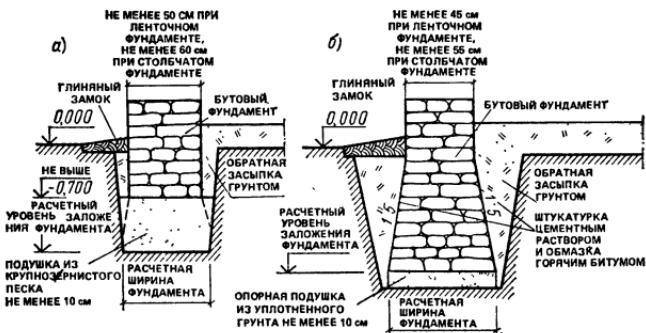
Кладка бутобетонных фундаментов в непучинистых (а) и пучинистых (б) грунтах
